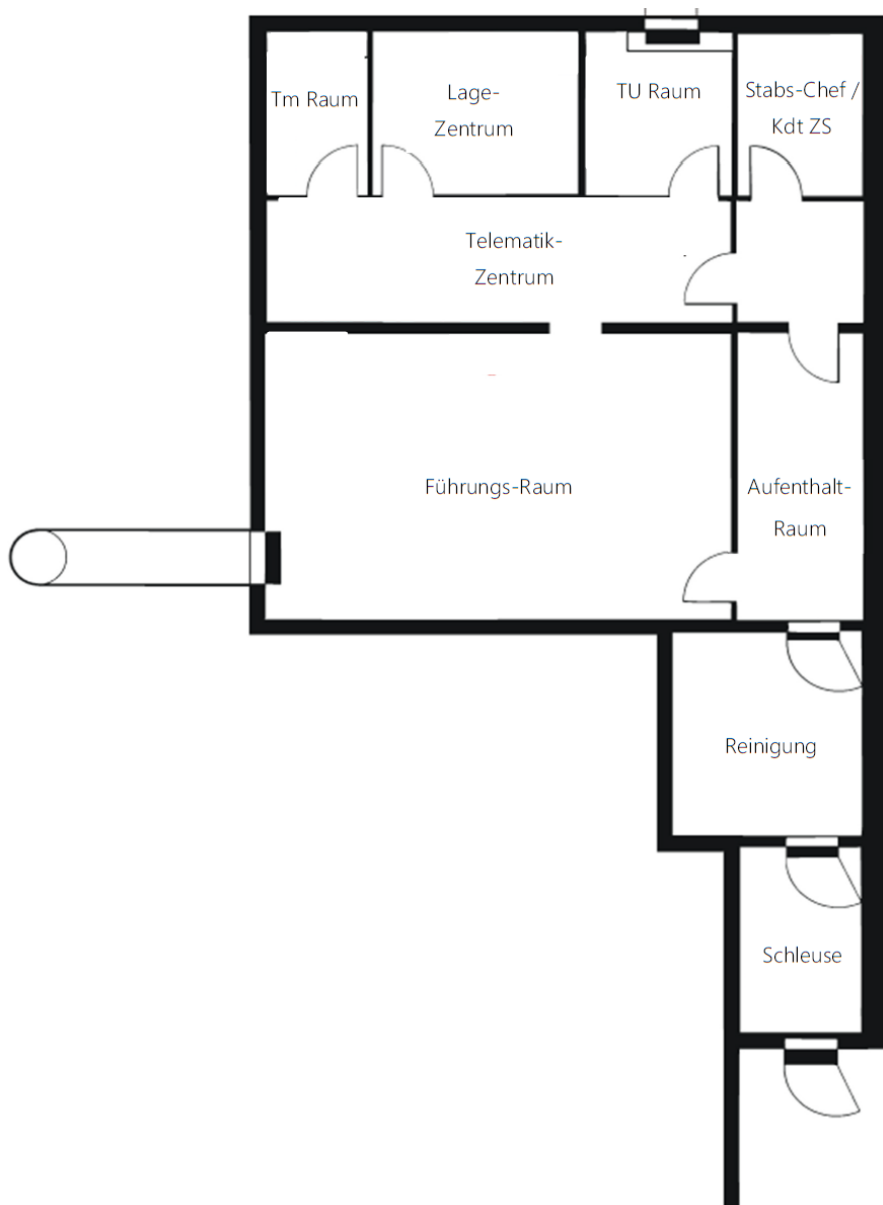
Grundriss Kommandoposten Typ II reduziert.
